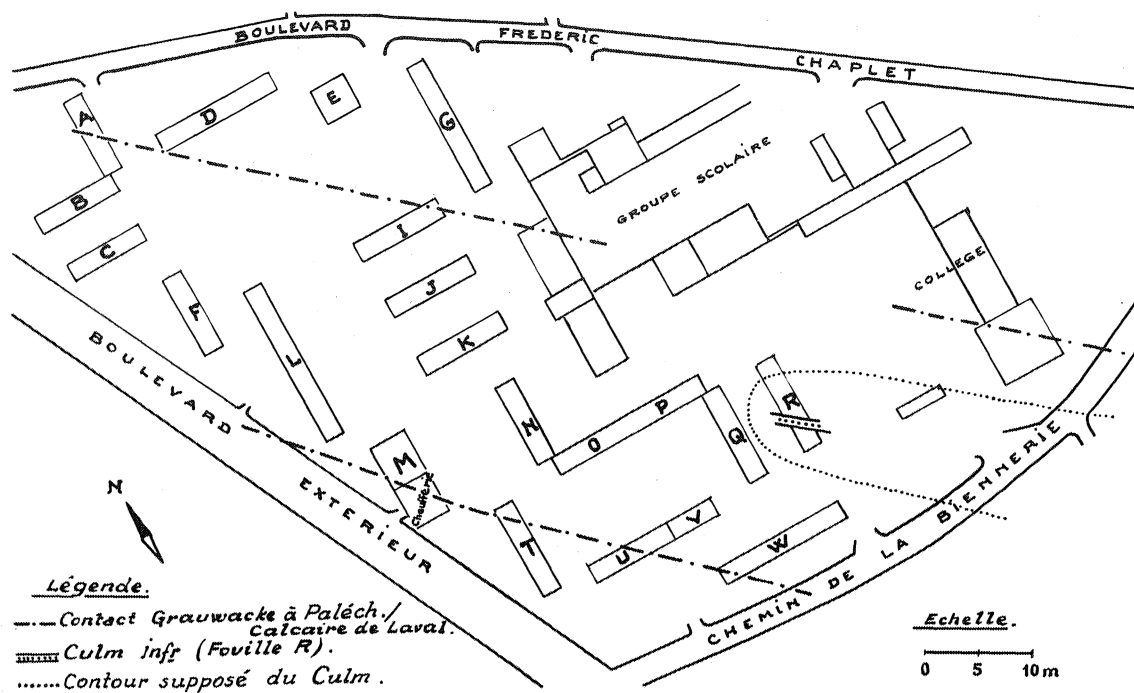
Plan de situation du chantier des Fourches (Laval).
